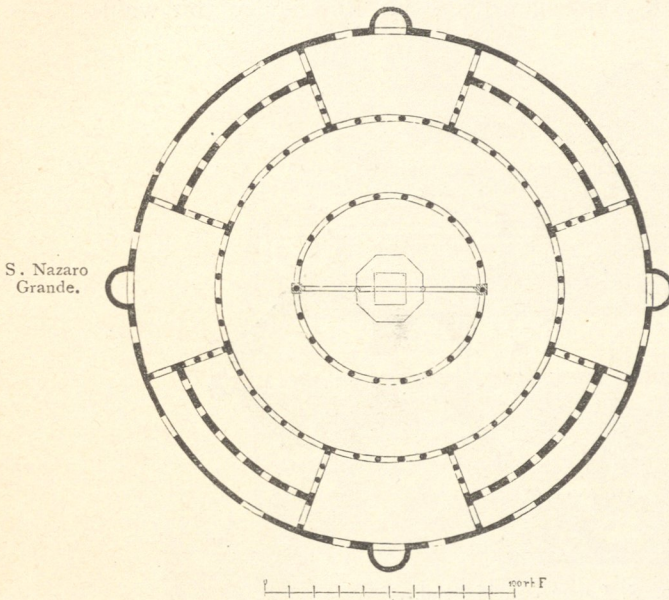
Grundriss von S. Stefano rotondo zu Rom.
